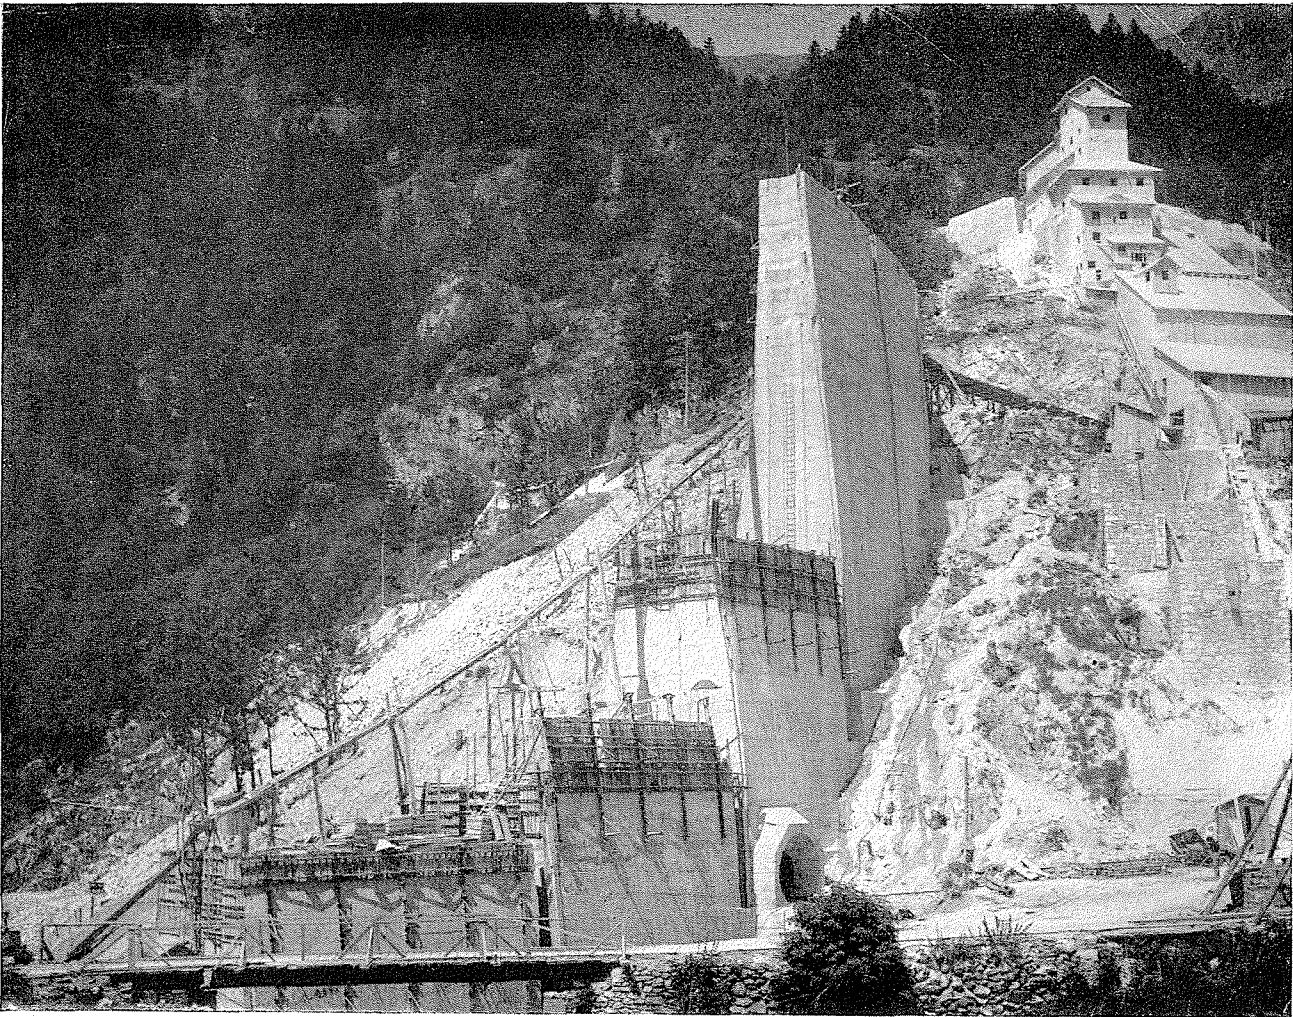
Le barrage en cours de construction. En haut à droite la station de concassage. Au premier plan, l'entrée de la galerie de prise.
